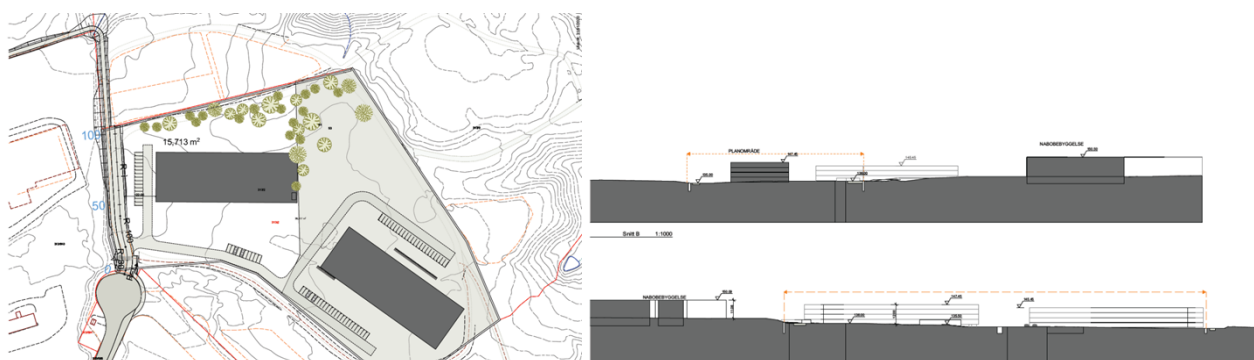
Lokalisering av planområdet vist med planomriss ved tilgrensende reguleringsplaner.
